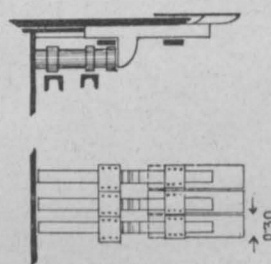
Triebpfahl-Detaills. (Elbetunnelschild, Hamburg).
